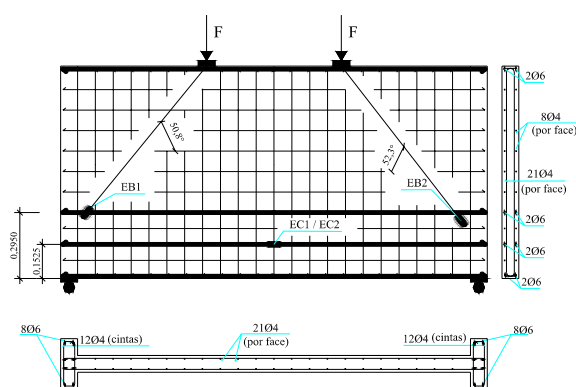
Armaduras passivas e localização dos extensómetros
